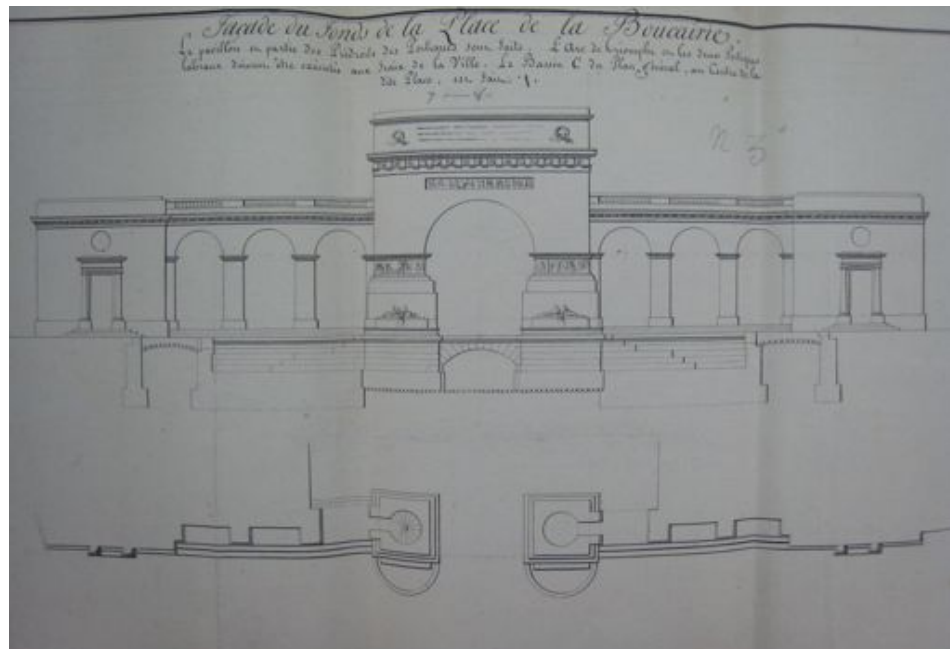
Façade du fond de la place de l'Abreuvoir (anciennement place de la Bouquairie) - (ADG)
